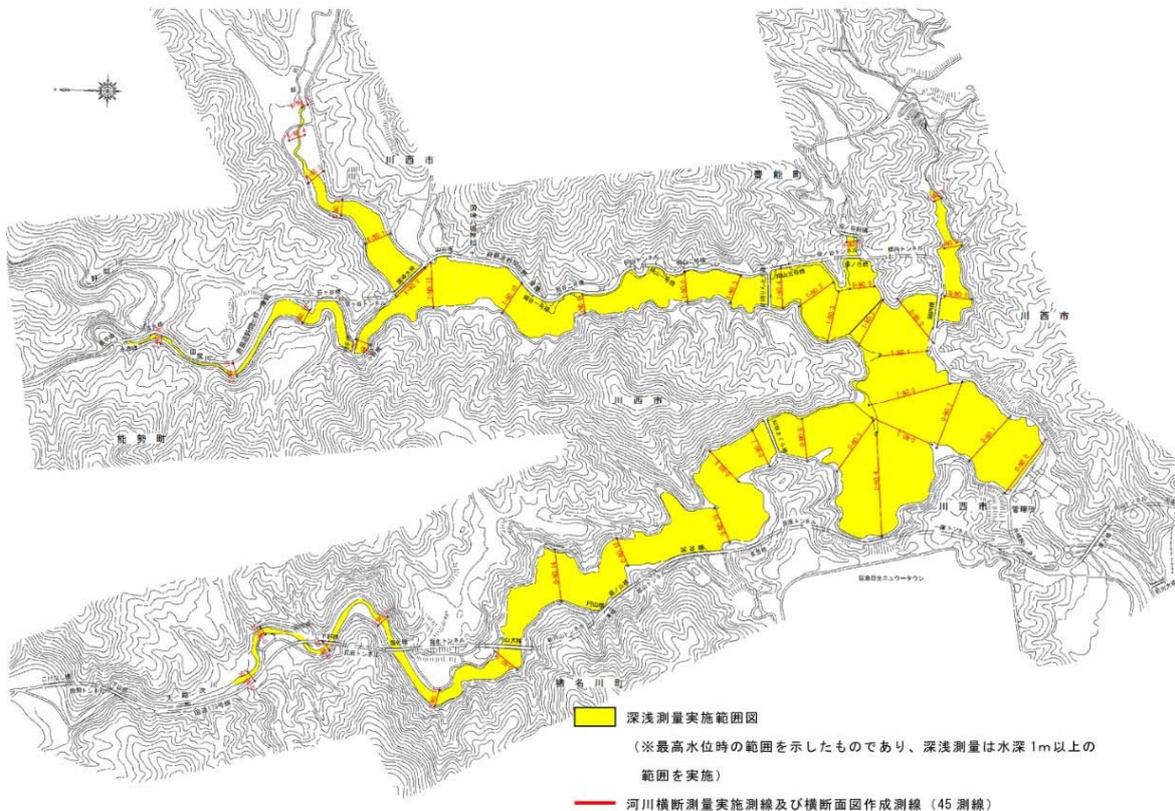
一庫ダム堆砂測量平面図(測線図)
